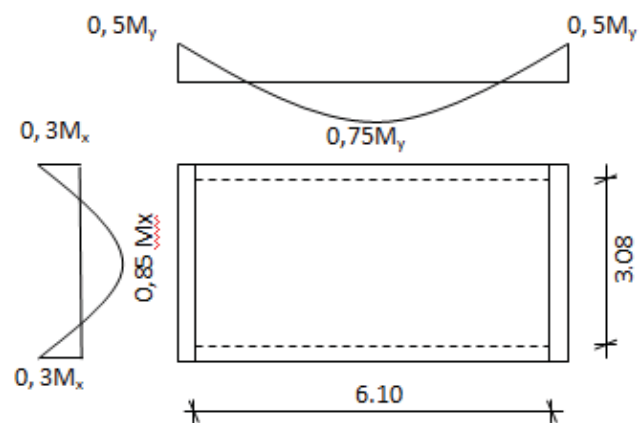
Panneau de dalle appuie sur 4 coté
